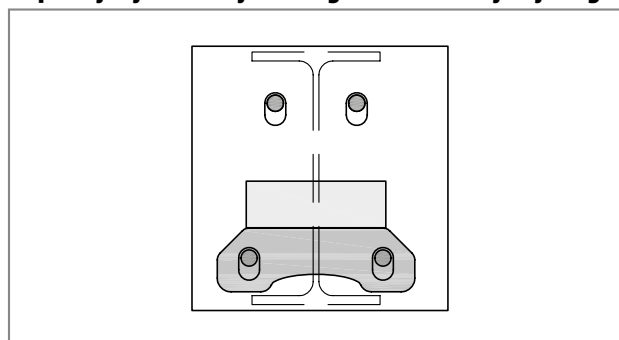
Schöck Isokorb®: zasukani in premaknjeni elementi zaradi pomanjkljivega fiksiranja lege med betoniranjem
